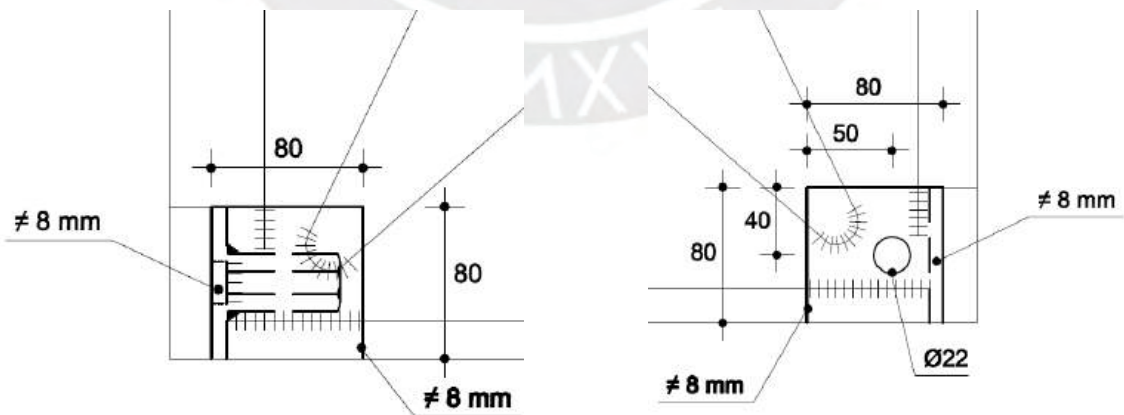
Detalle Vista 1 y Vista 2 de placa unión entre módulos
